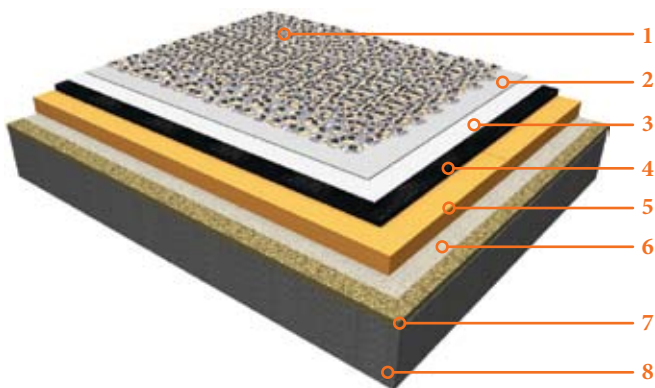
Кровля с балластным креплением гидроизоляционного слоя:
